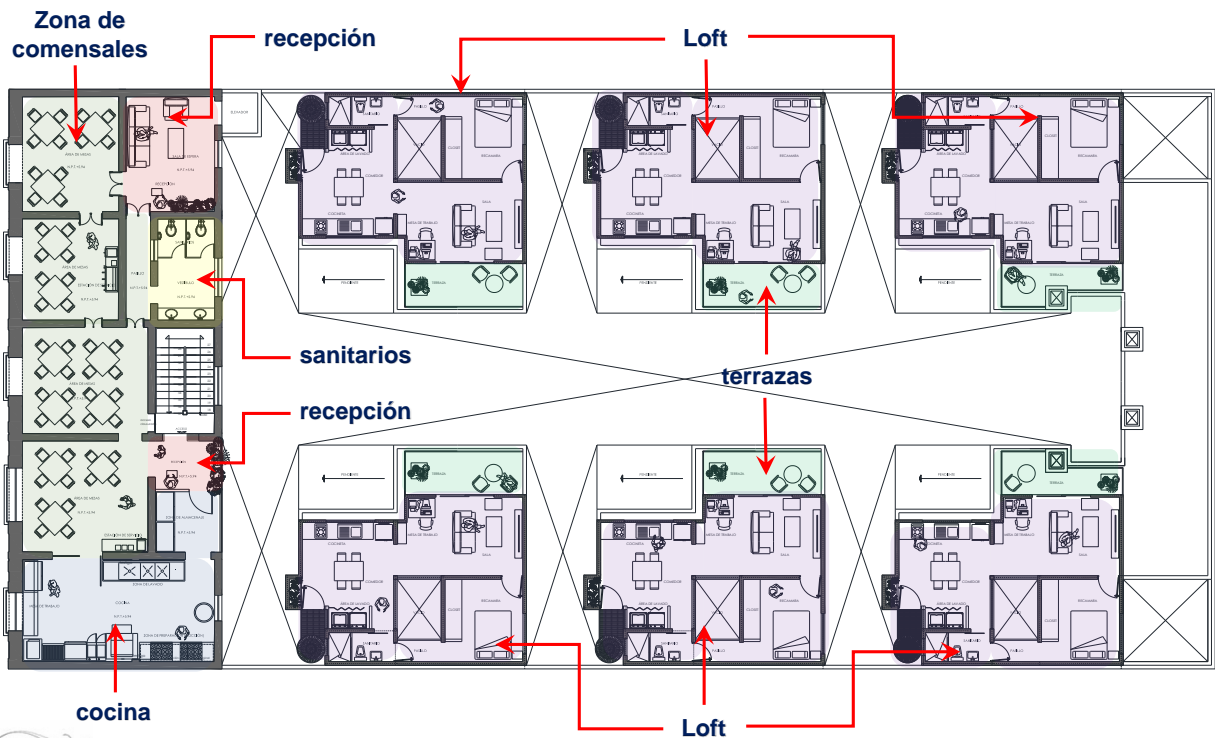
y 119. Planta de conjunto y planta de primer nivel con la nueva propuesta.
